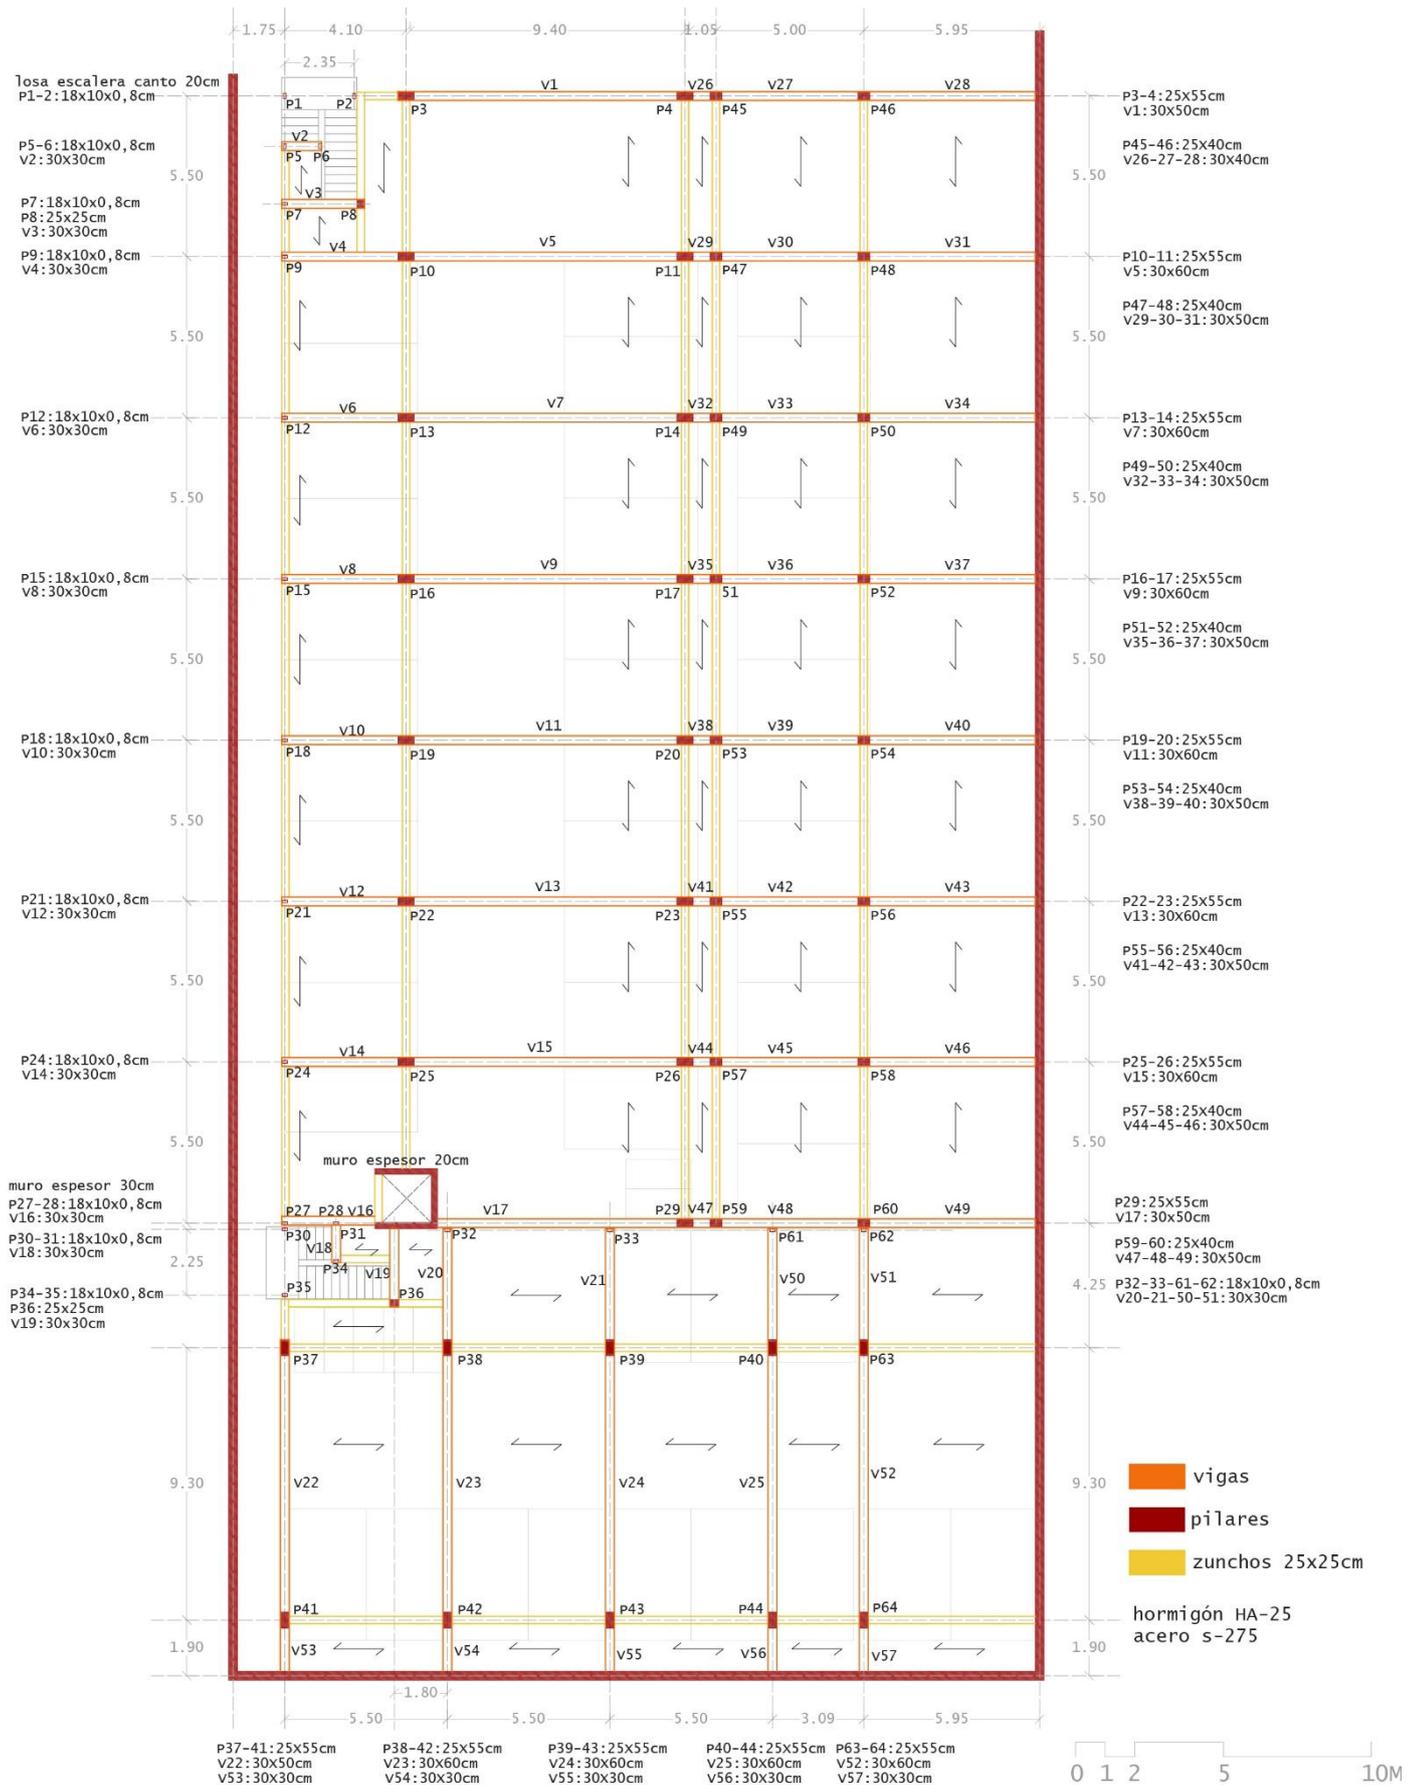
Planta estructural del forjado 1 (Modelo 3)
